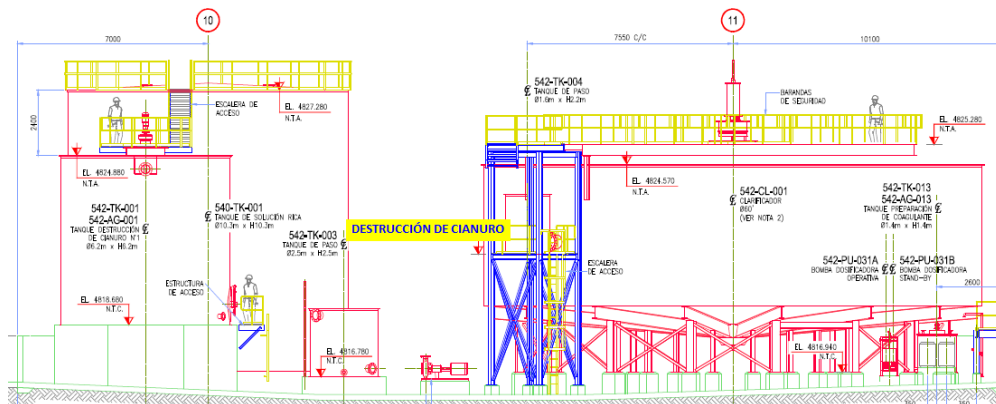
Elevación de Tanques y Espesador en zona de Destrucción de Cianuro (Fuente: Empresa consultora ABC)
